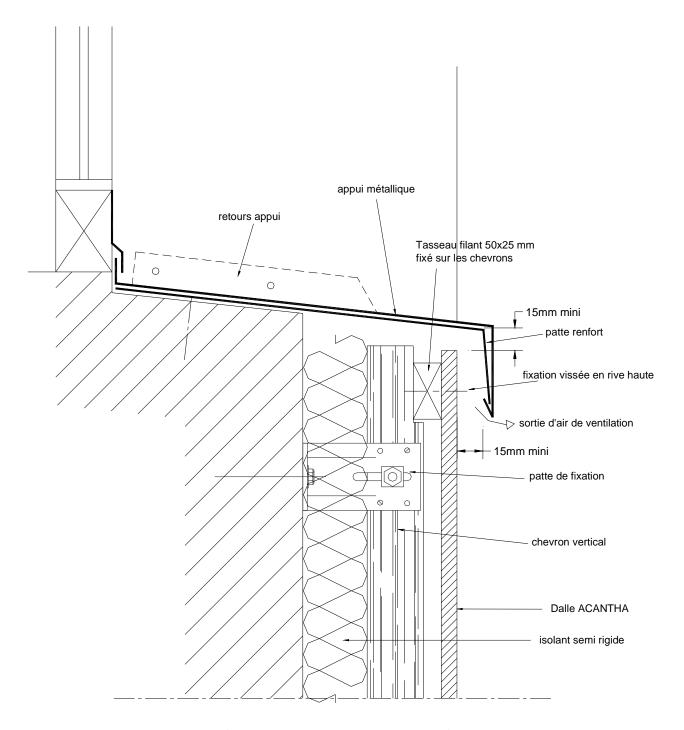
Habillage métallique en appui de baie avec fixation vissée des dalles en rive haute
